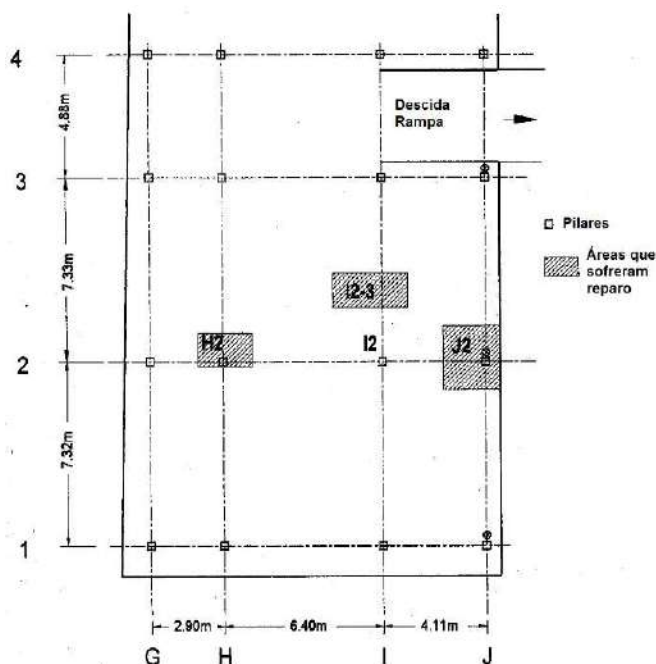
Planta da quarta laje do Pipers Row Car Park com indicação das áreas reparadas (WOOD, 2003)
